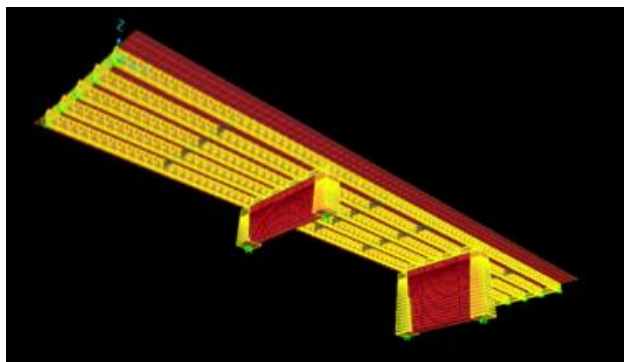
Modelo estructural en 3D, planta inferior (elaborado con SAP 2000)
